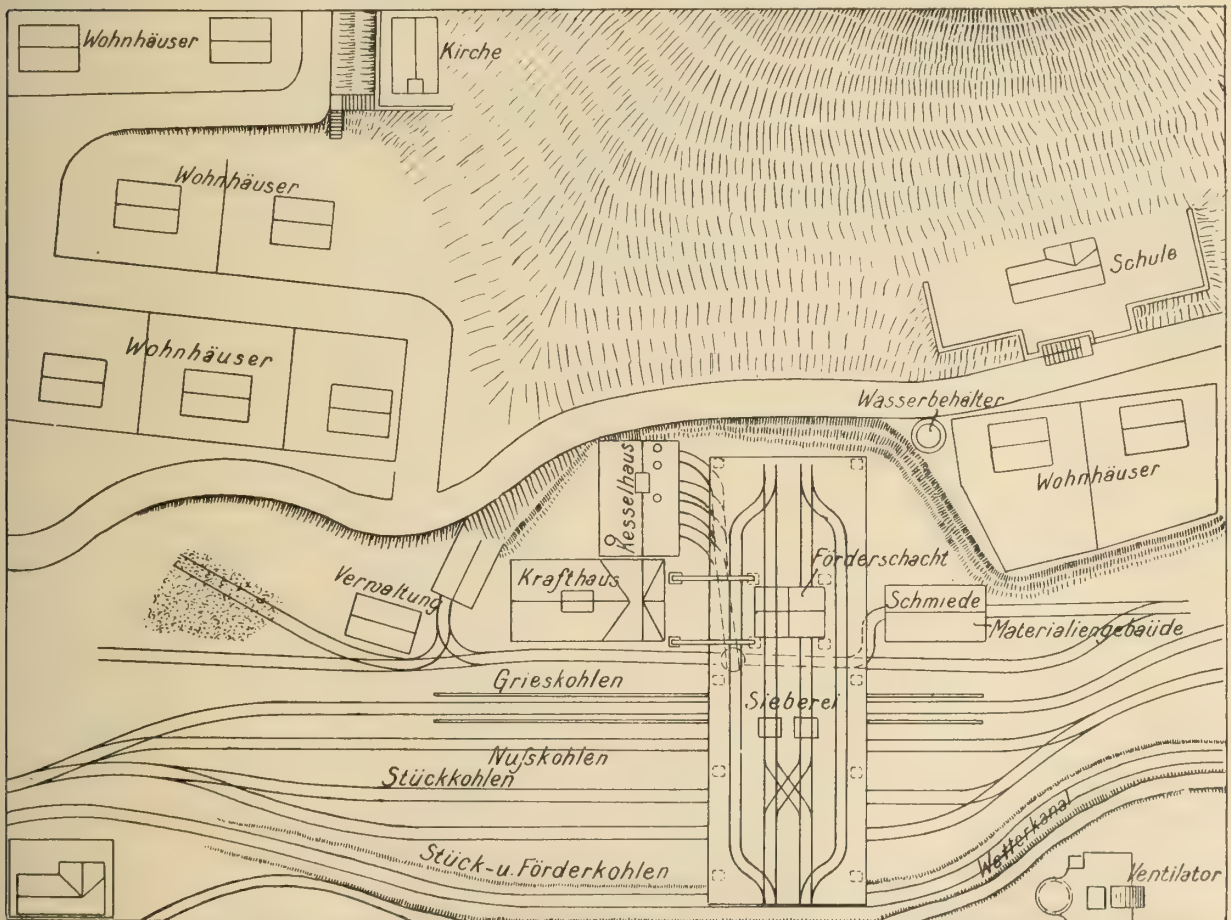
Lageplan der Tagesanlagen auf First Pool - Grube Nr. 2 der Pittsburg Coal Co.
